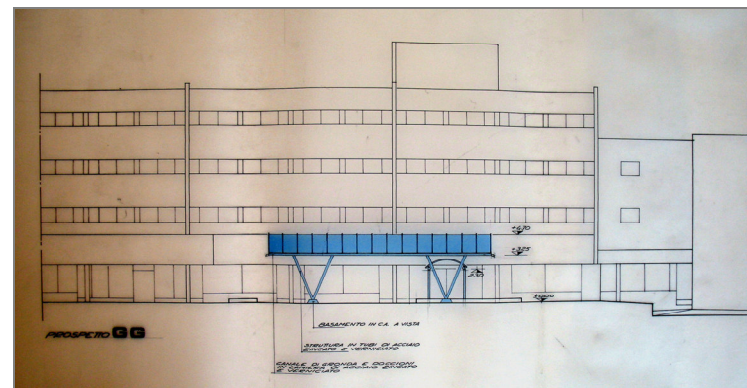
prospetto sud ovest corpo A (fonte CSAC – stralcio tav. 2, archivio n. 400-1)
